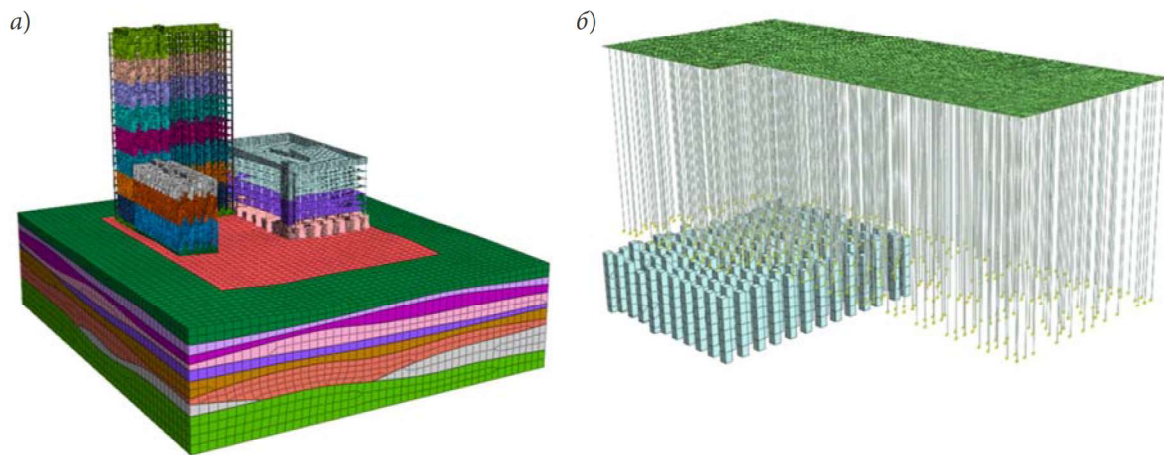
Расчетная схема: а — общий вид; б — модель грунтоцементных колонн и фундамент секции 2
